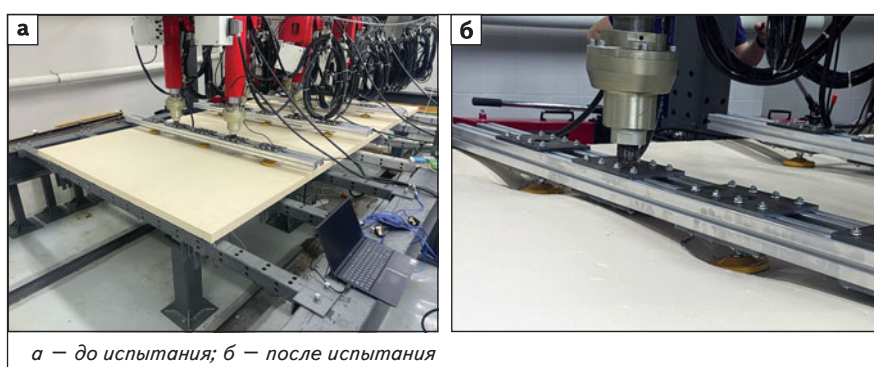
Испытание полимербетонной панели на положительную ветровую нагрузку
